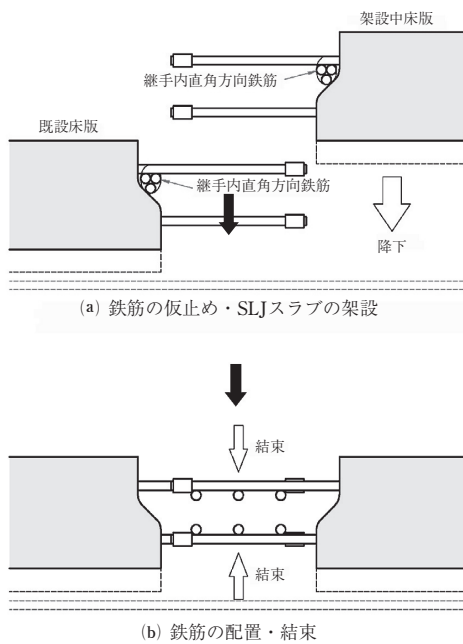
接合部の橋軸直角方向の鉄筋の施工方法
